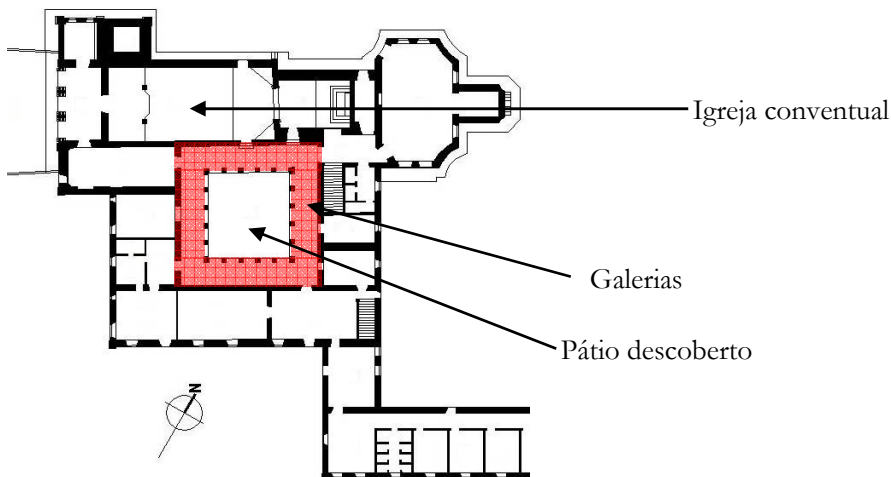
Convento de Santo Antônio, Igarassu, Pernambuco - Planta do pavimento térreo.
